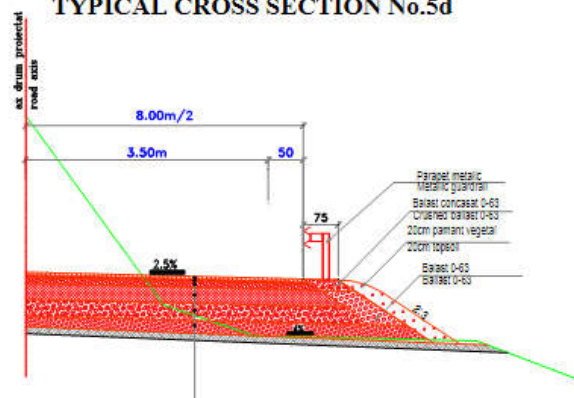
Profil transversal tip nr.5d - structură carosabilă nouă
